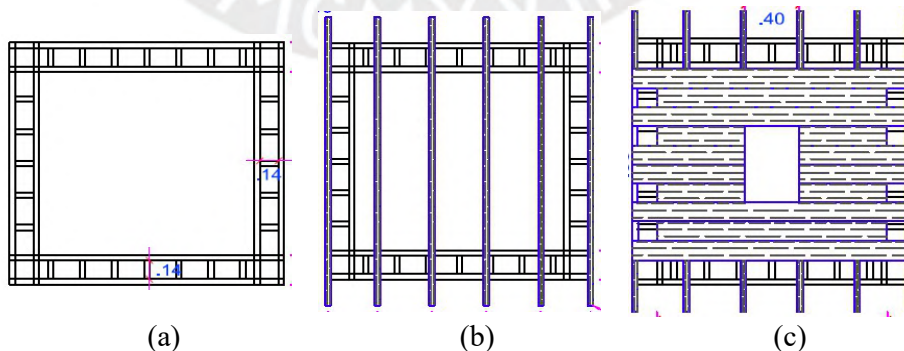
Vista en planta: (a) Viga collar, (b) Viguetas y (c) Entablado (Pando, 2017)
